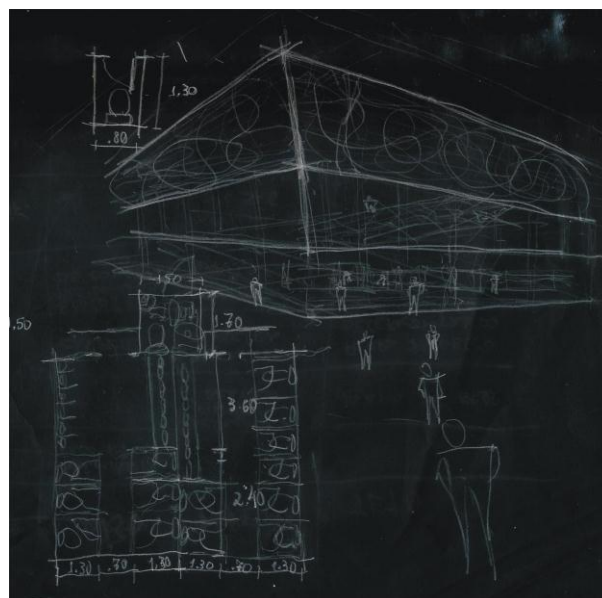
Croqui de fachada em perspectiva e de banheiro de público.
